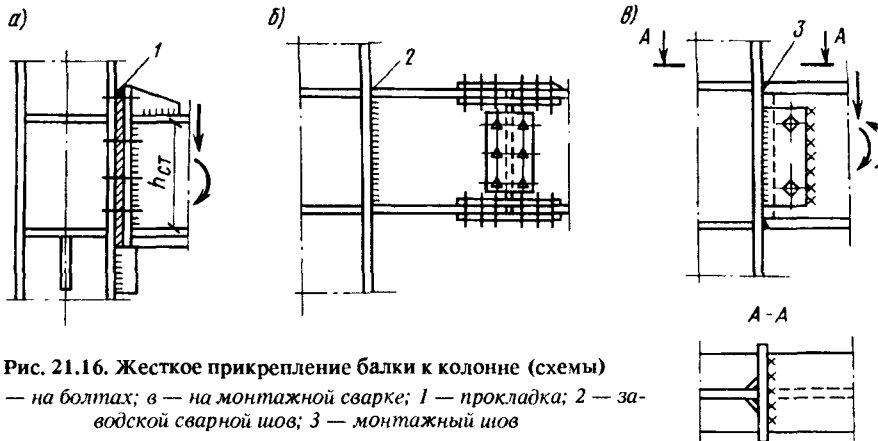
Жесткое прикрепление балки к колонне (схемы)
